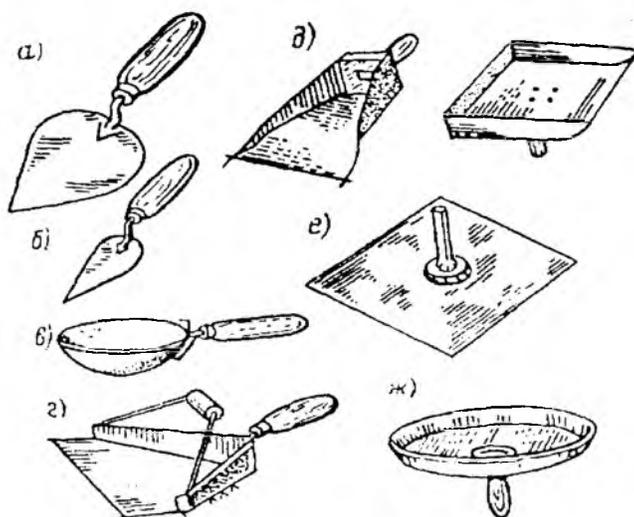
Ручные инструменты для нанесения штукатурного раствора
